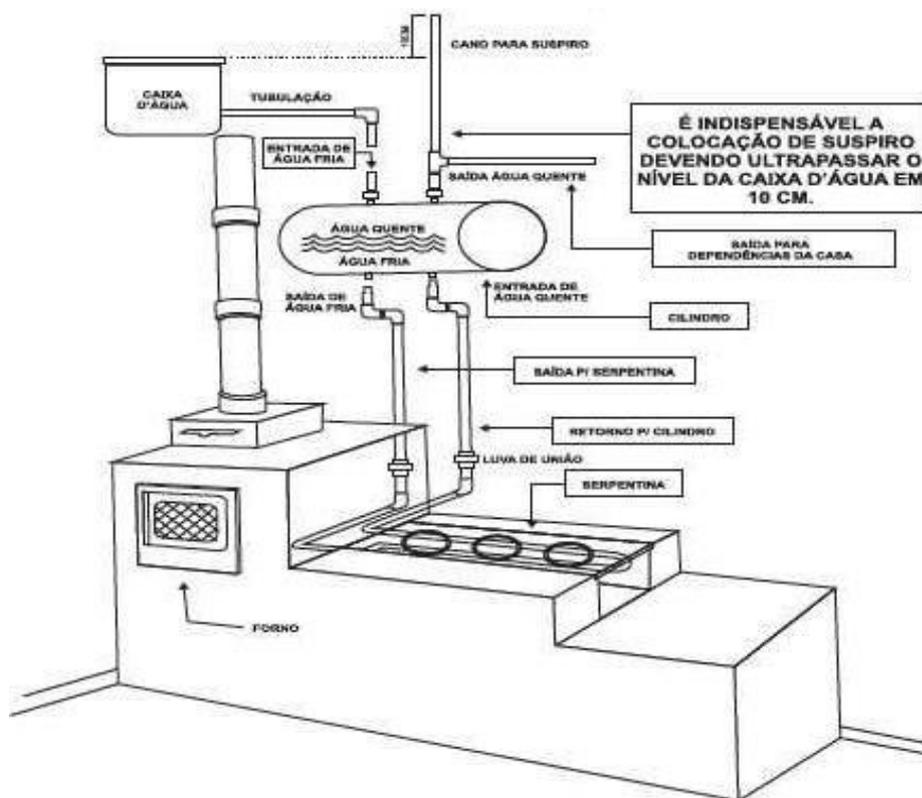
Esquemática da instalação do Sistema de aquecimento de água por boiler e serpentina
